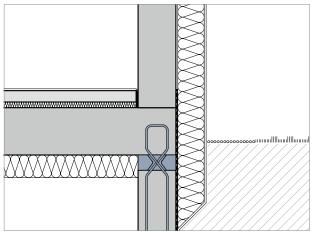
Schöck Sconnex® type W pour mur extérieur et isolation sous la dalle
